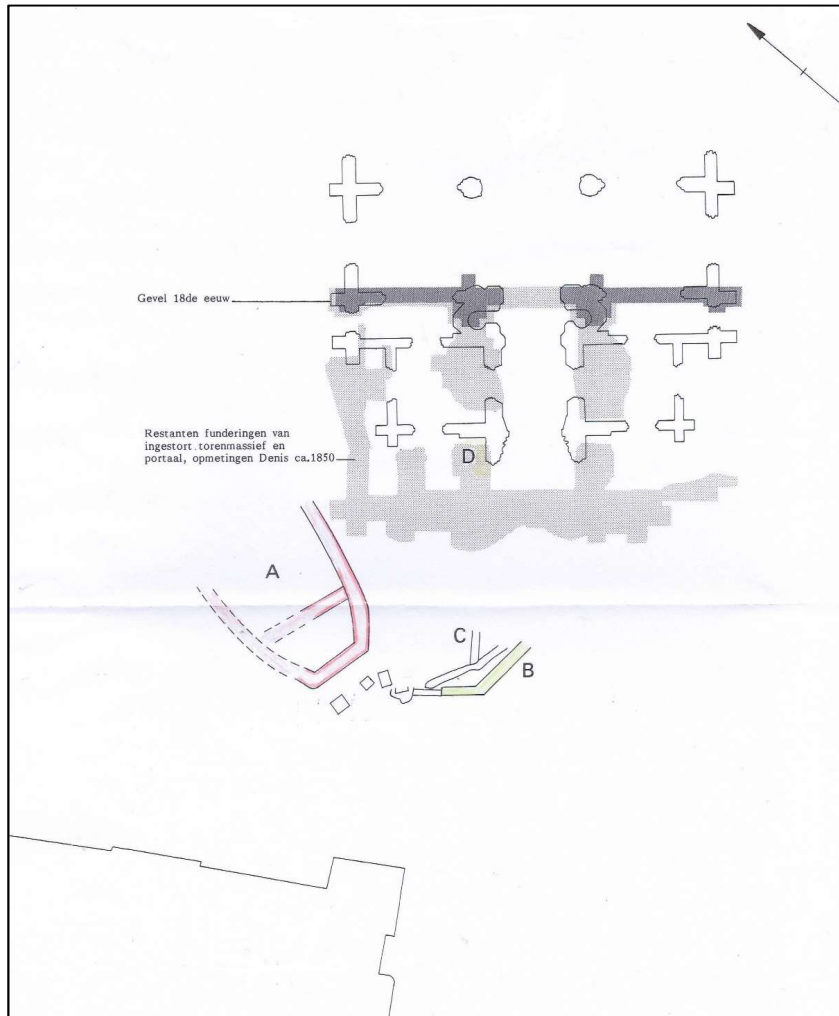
Plan van de in 1994 door het IAP aangetroffen sporen (Archief dekenij). De aangetroffen funderingen van de Klerkenkapel zijn in het rood weergegeven.
